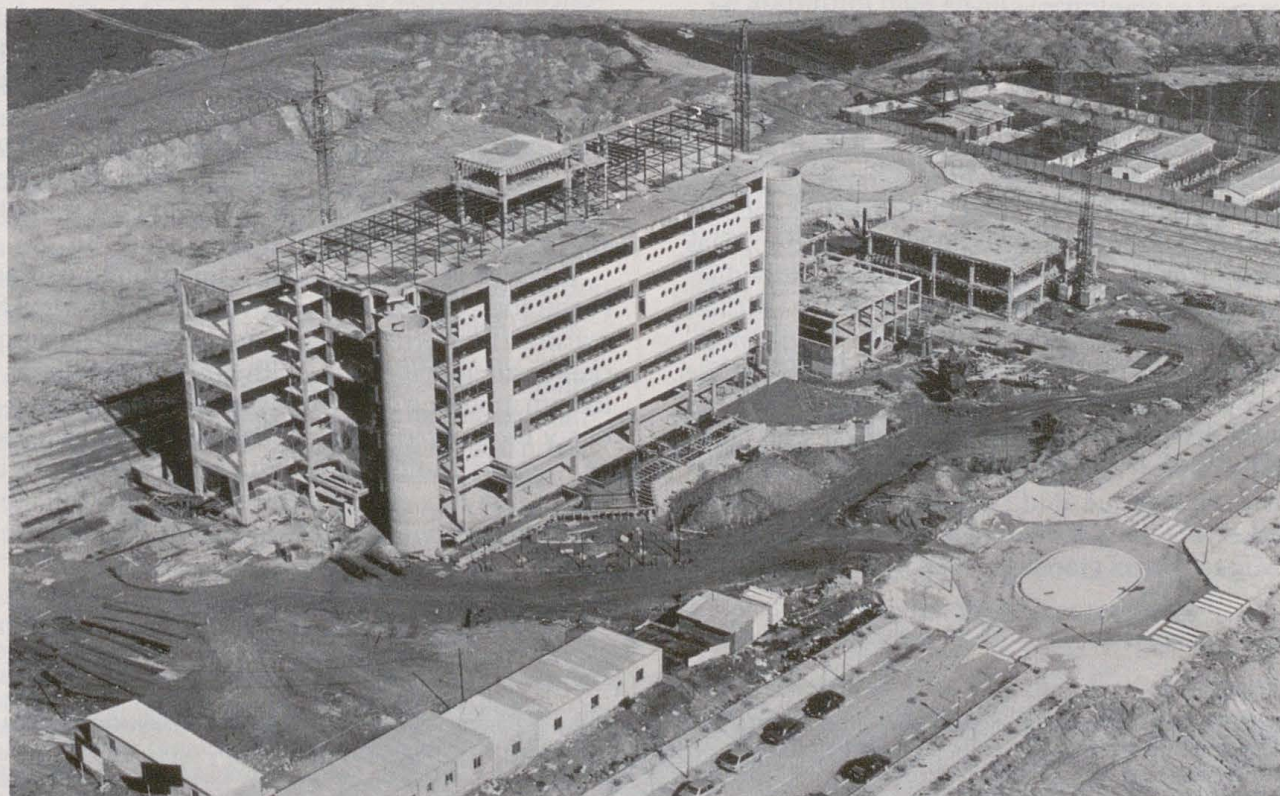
TERSSE & COLMENARES: Centro Nacional de Ingeniería Genética y Biotecnología. Fase de construcción. Vista SO.
